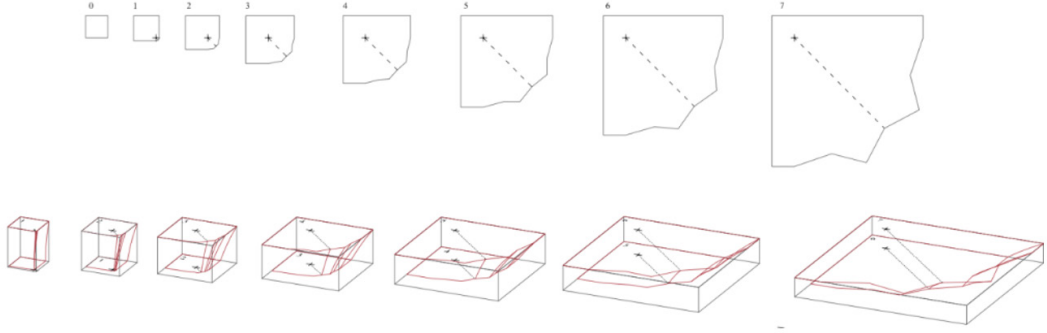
Temelinde bir çapraz tonoz planı olan 3 kenarlı Alara Han çeşme eyvan tonozu.
